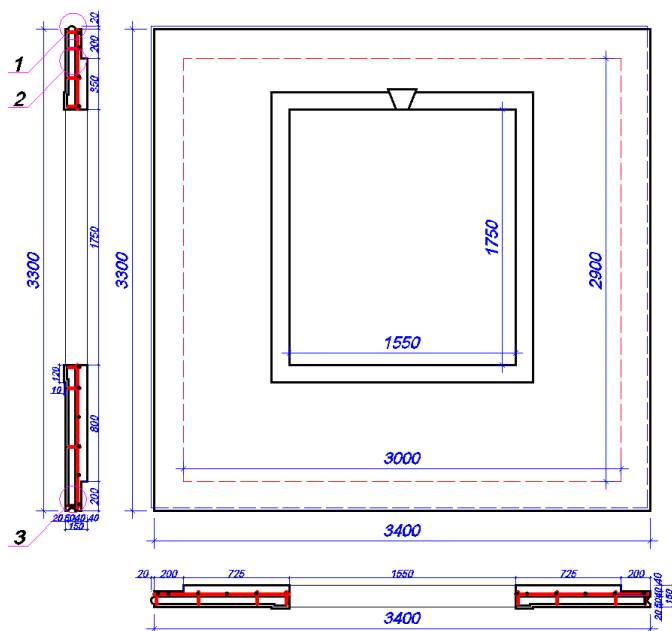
Фасад наружной стеновой панели, поперечное и продольное сечения
